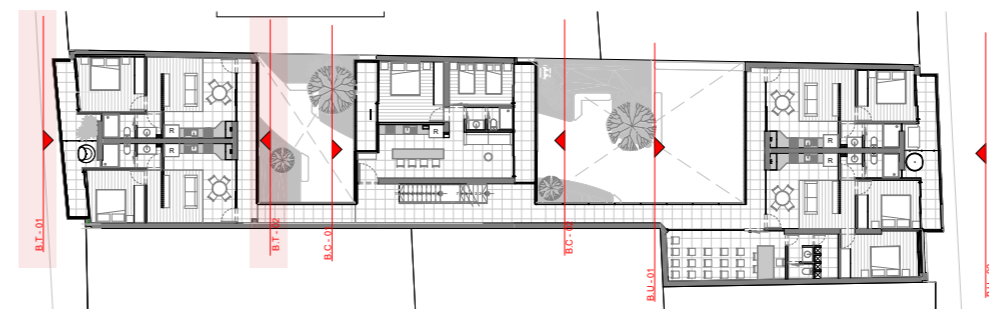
Planta de referencia para secciones. Fuente: Elaboración propia.
